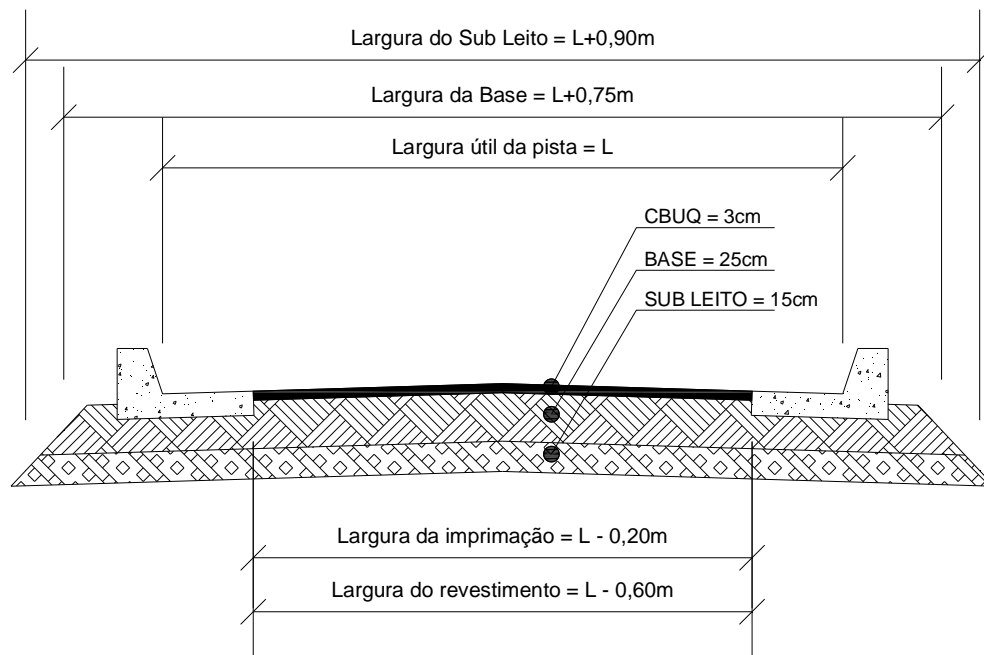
Larguras das camadas do pavimento, das pistas coletoras e arteriais, para caimento duplo (abaulada)
